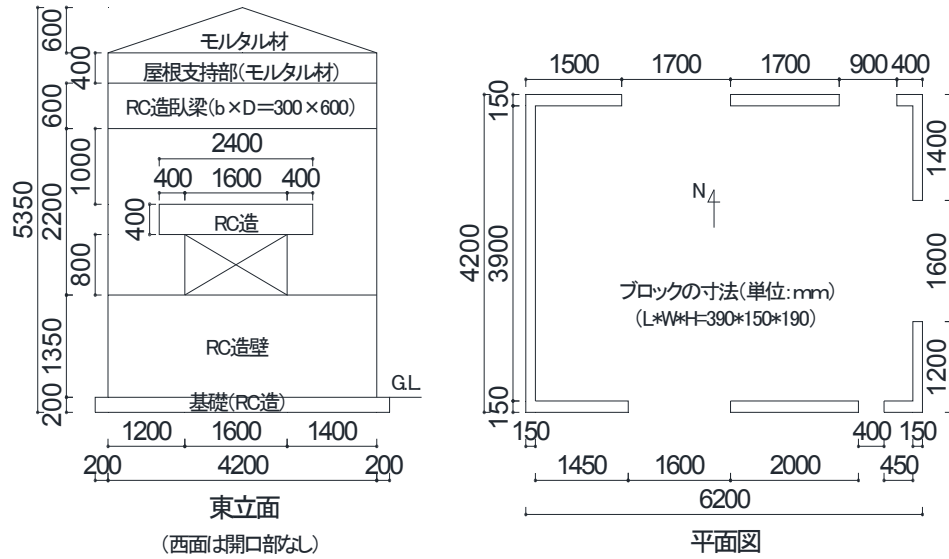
調査対象建物 立面図・平面図 (単位: mm)
